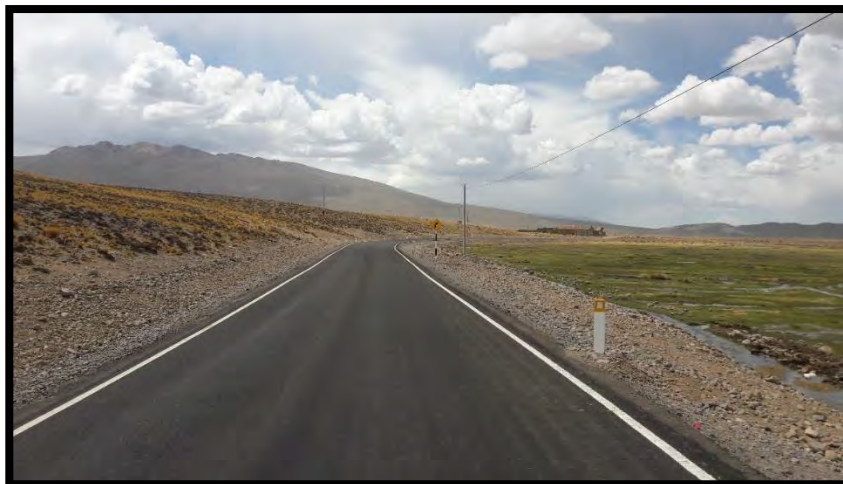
Pavimento básico culminado. Ancho de la vía 4 metros
